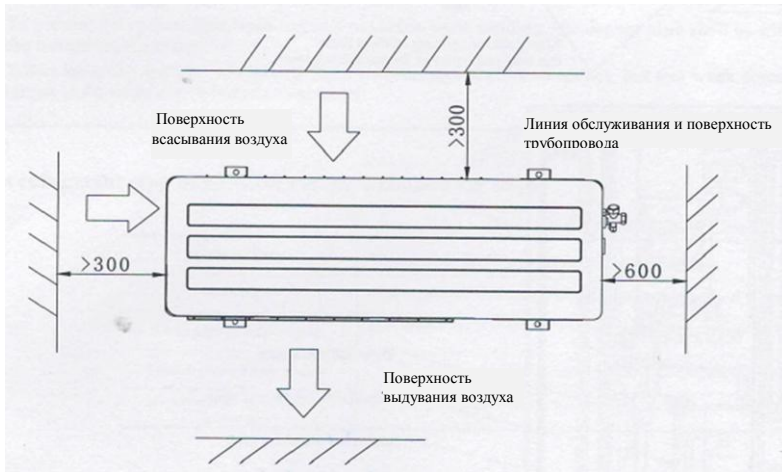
Схематический эскиз I для установки и обслуживания наружного блока
